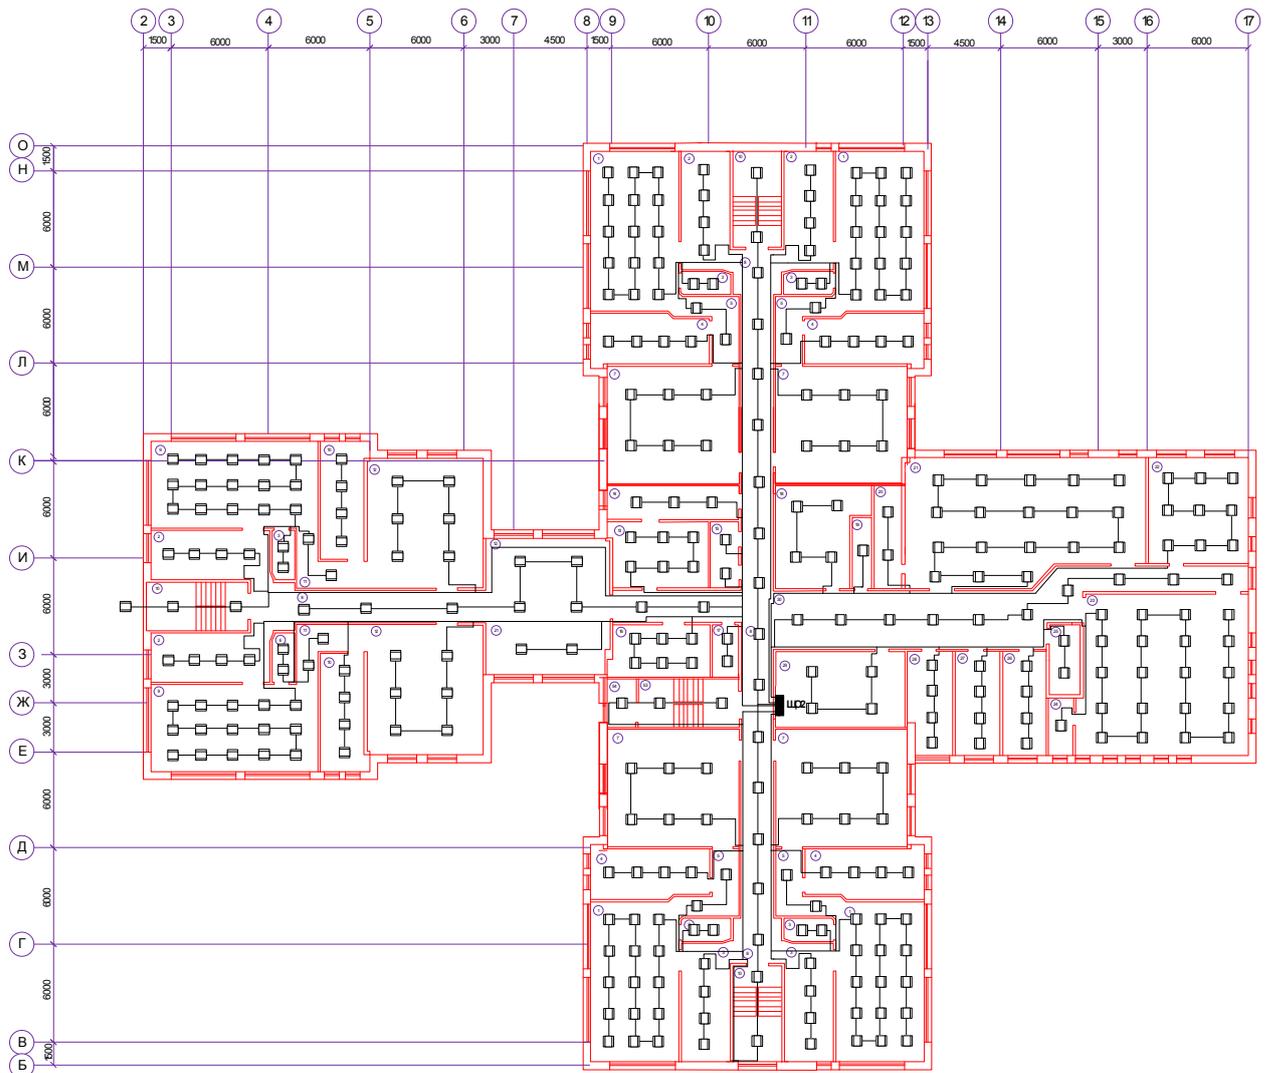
План 2-го этажа детского сада с разводкой осветительной сети
